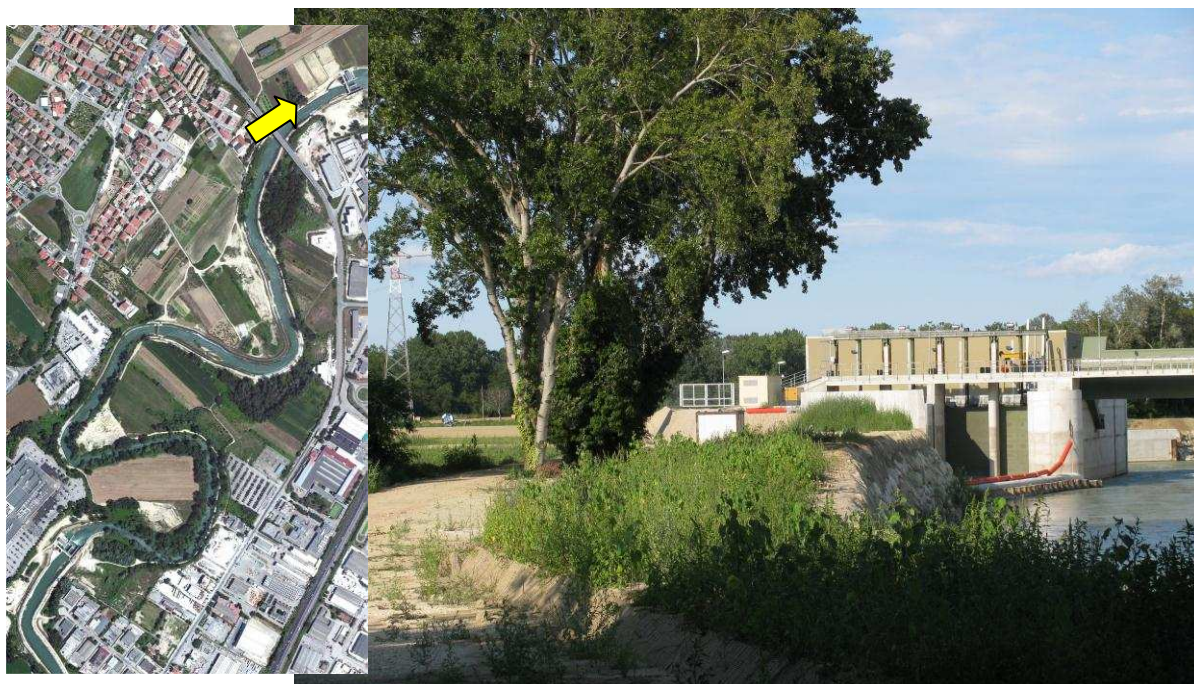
Rilevati arginali presso la centrale di Santa Teresa.
